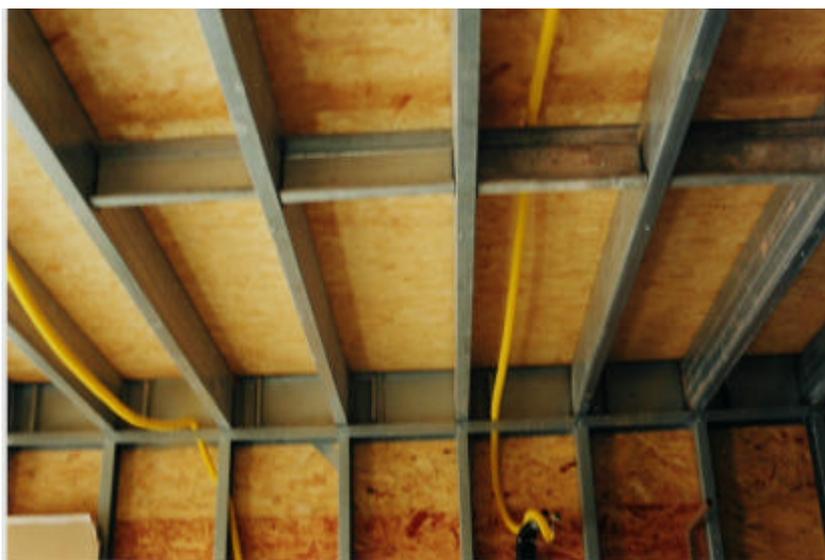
Vista da estrutura do piso com vigas em perfis galvanizados e contrapiso em OSB.
